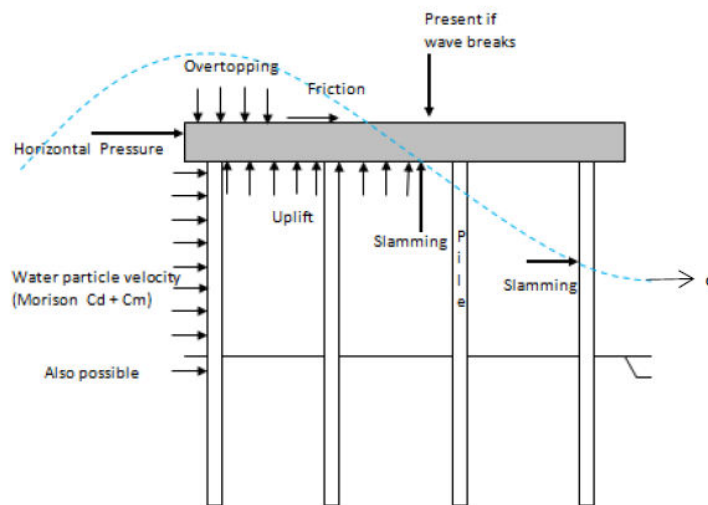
Wave-in-deck loads pormenorizadas (Bron, 2013)
